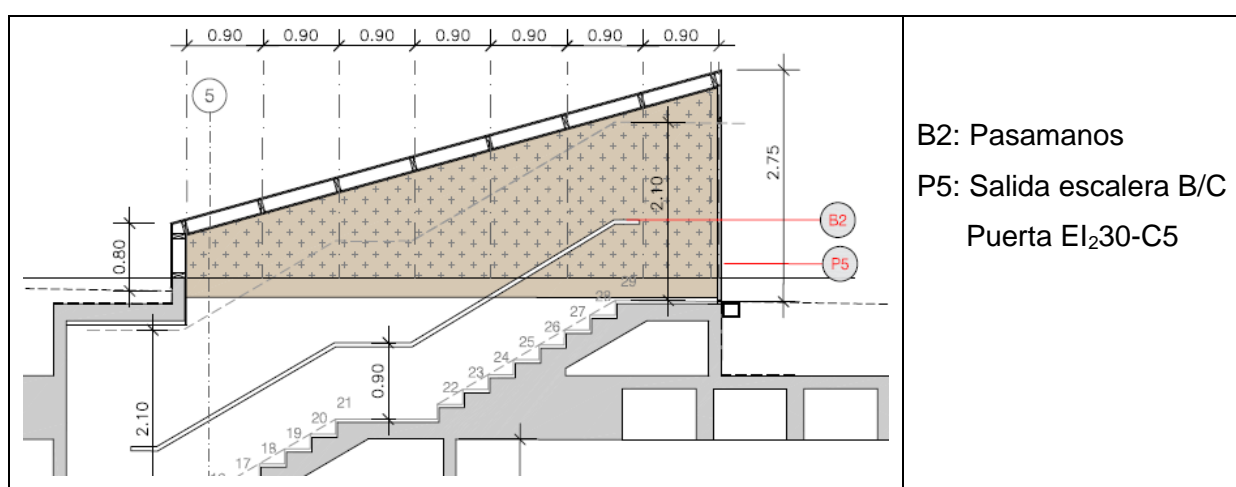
Casetón de la slaida B (equivalente al de la salida C)
